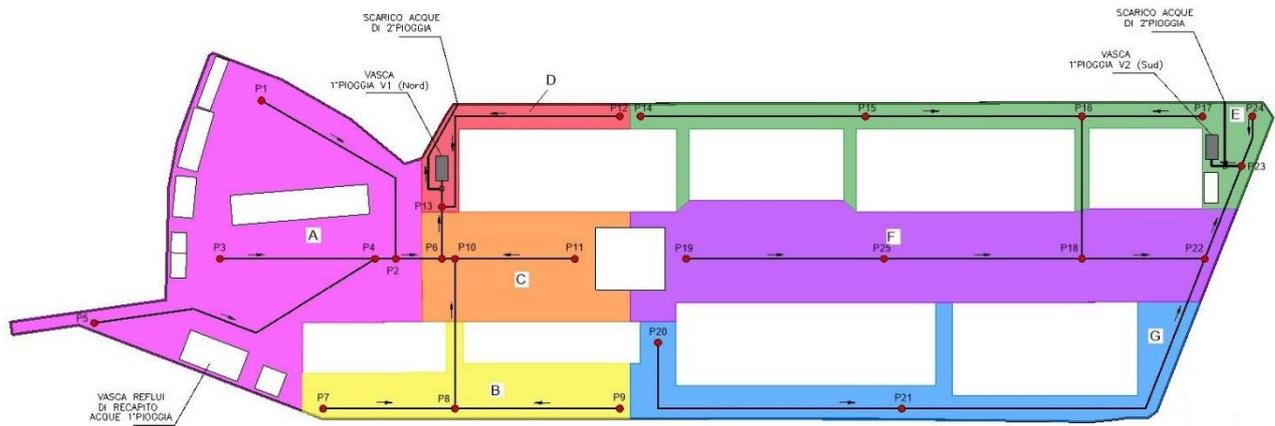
Planimetria Rete principale di raccolta acque meteoriche
